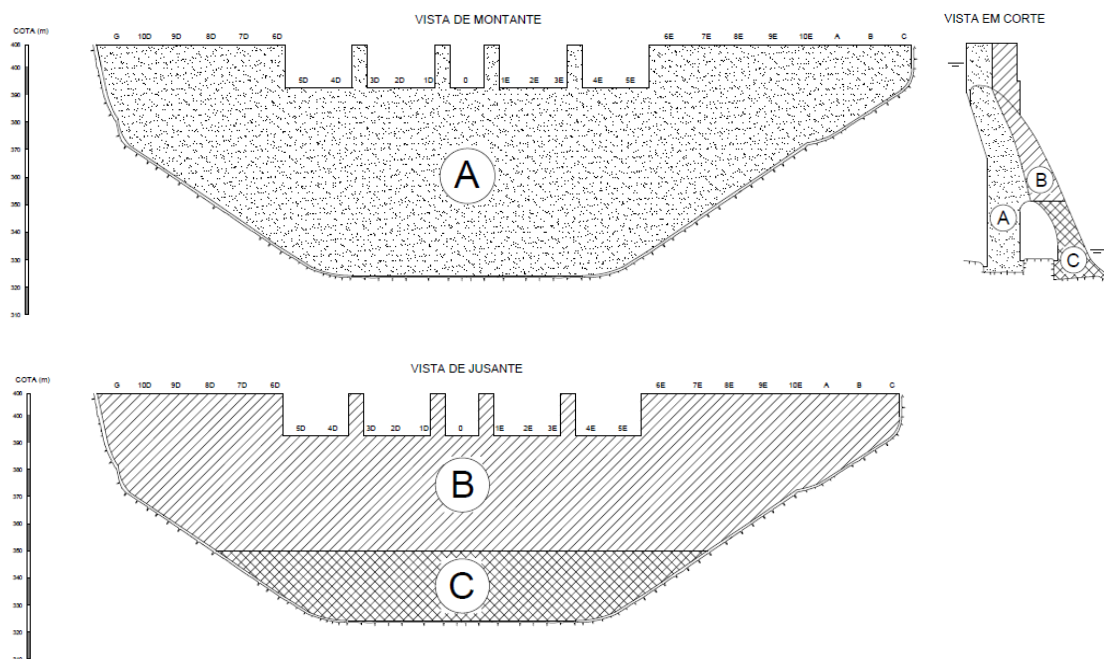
Zonamento da barragem. Vista de montante e corte em cima e vista de jusante, em baixo.
